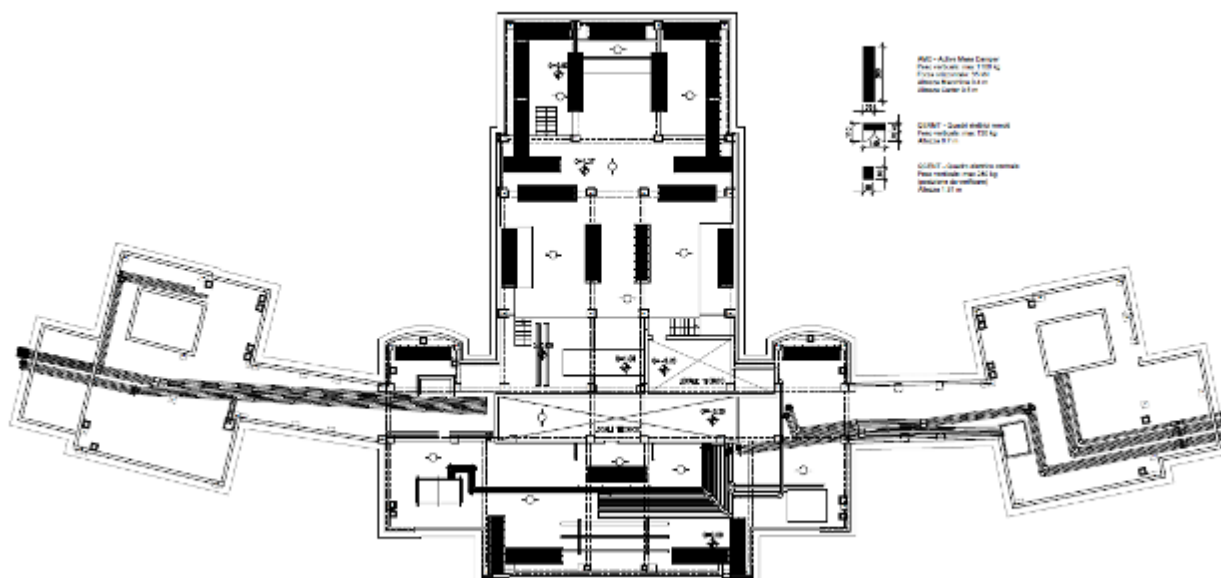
Disposizione planimetrica delle 24 unità macchina del sistema attivo Electro-Pro 20x o similare
